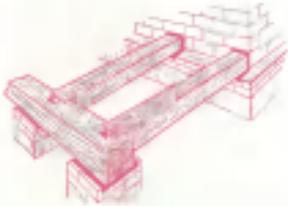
Общий вид готовой обвязки веранды с пакетами для столбов.
